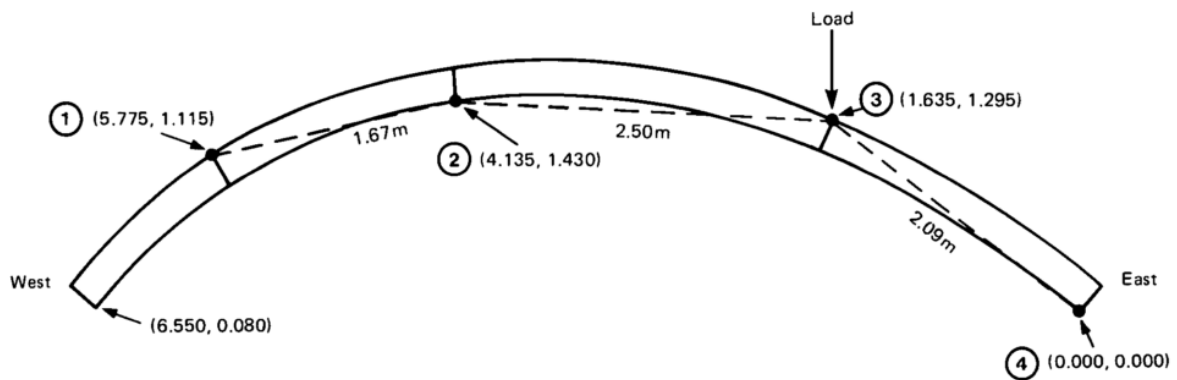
ábra – Prestwood Bridge tönkremenetel állapota [31]
